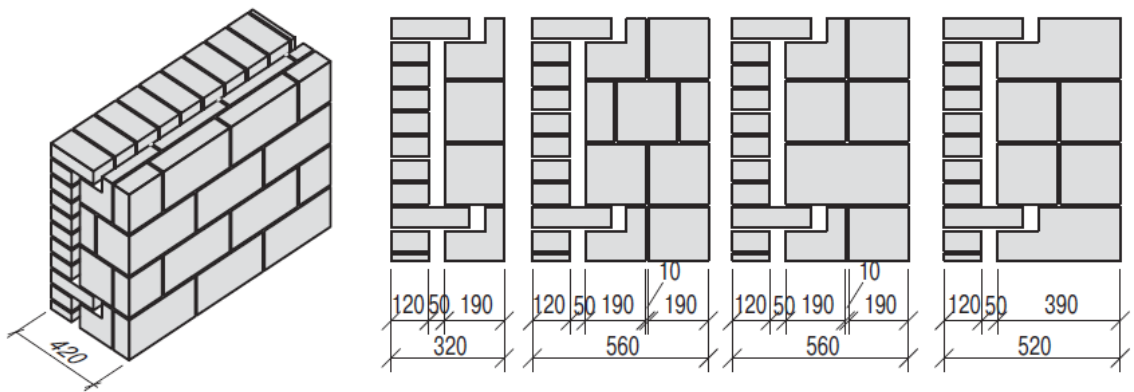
Кладка из бетонных камней (блоков) с облицовкой кирпичом с воздушной прослойкой. 1951 г.
